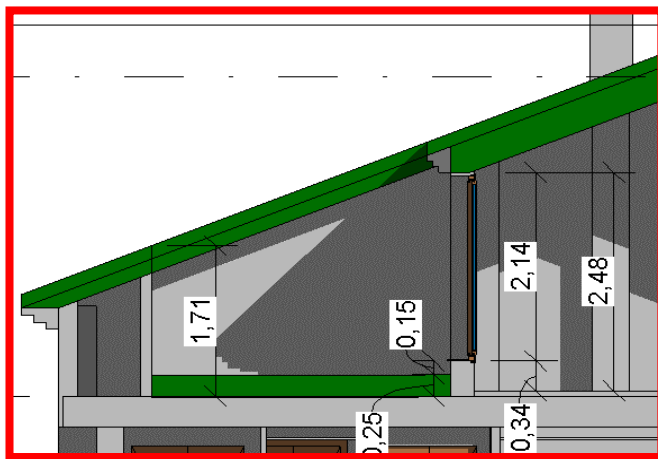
Detalle de salida a terraza aprovechamiento bajo cubierta, modelo con solución de prueba. 2014. Elaboración propia
